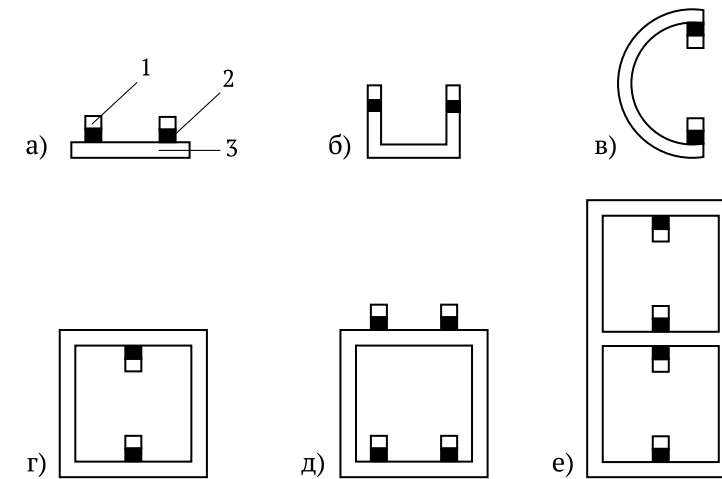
Схемы размещения поперечных планок в путевой структуре СТС (варианты): а, б, в, г – одноярусная СТС; д, е – двухъярусная СТС; 1 – рельс; 2 – электроизолятор; 3 – поперечная планка
